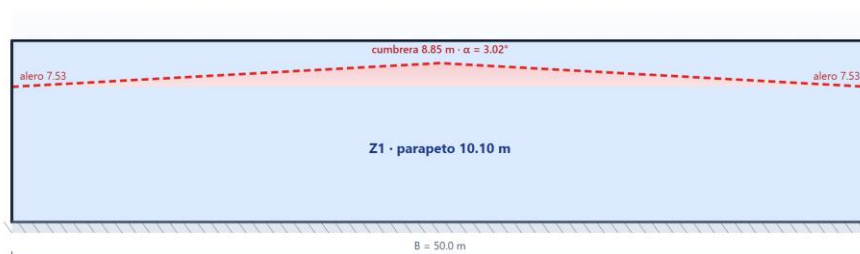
Sección transversal (cara corta, $B = 50 \text{ m}$): alero a 7,53 m, cumbrera a 8,85 m y parapeto Z1 que se eleva hasta 10,10 m.
